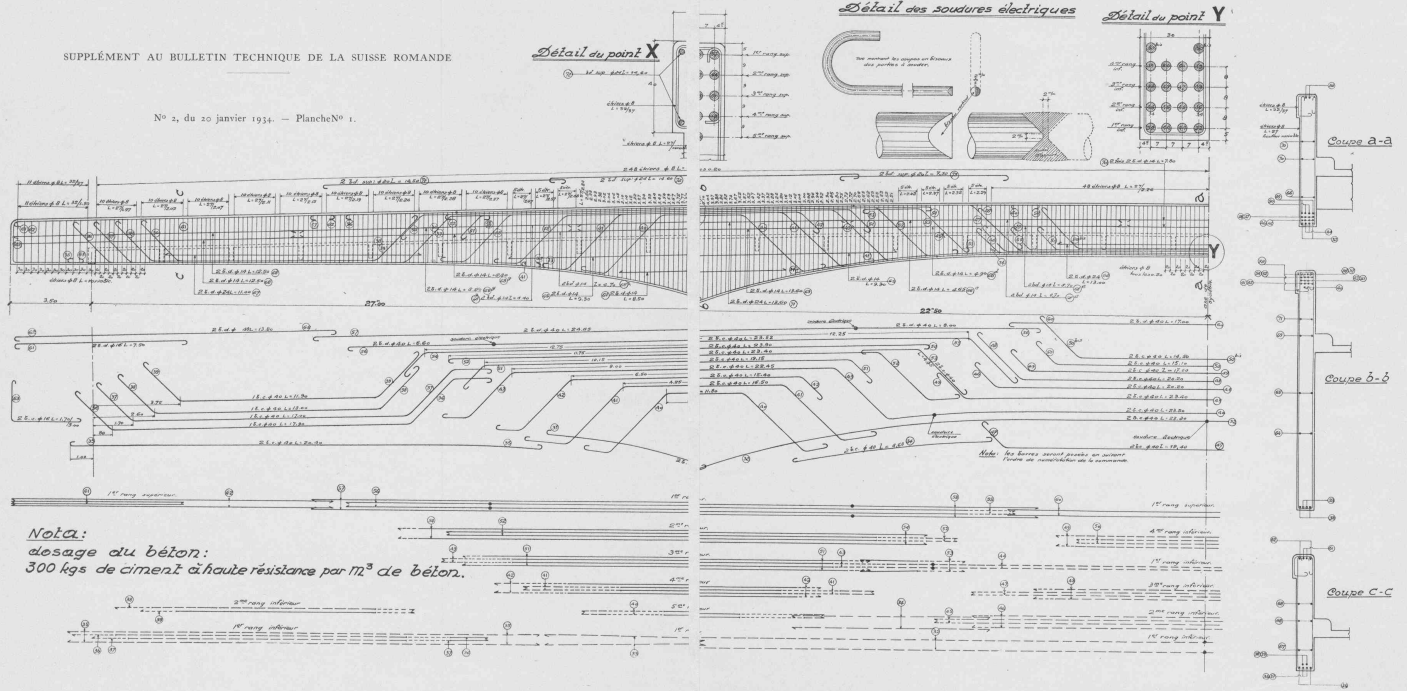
Pont sur le Rhône, à I — Armature des poutres principales.
